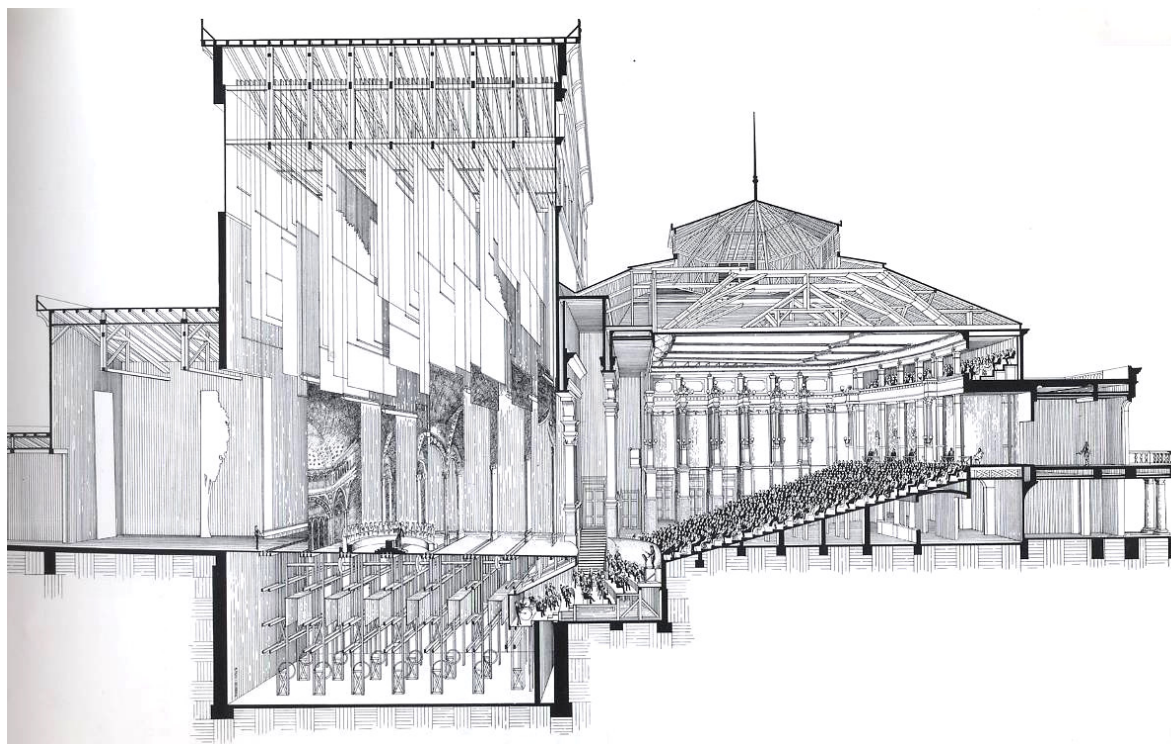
Bayreuth Festspielhaus sezione longitudinale prospettica.
